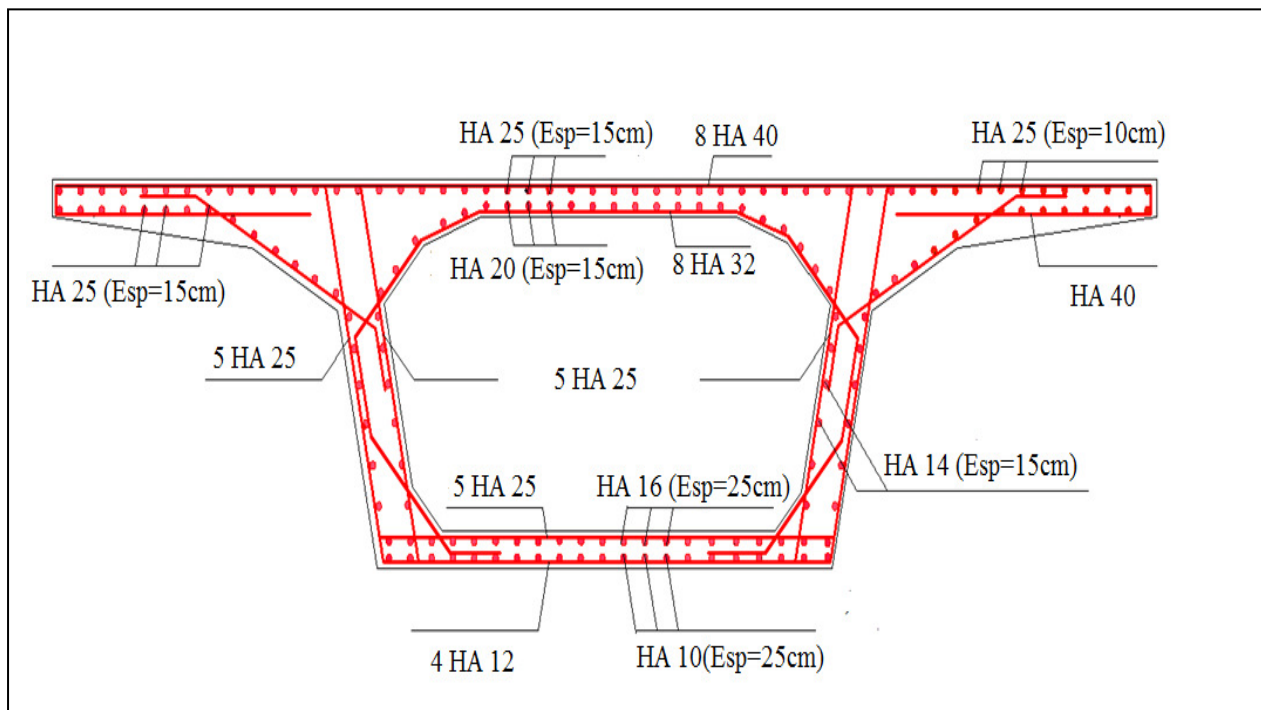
Schéma du Ferrailage du voussoir près de la culée.
